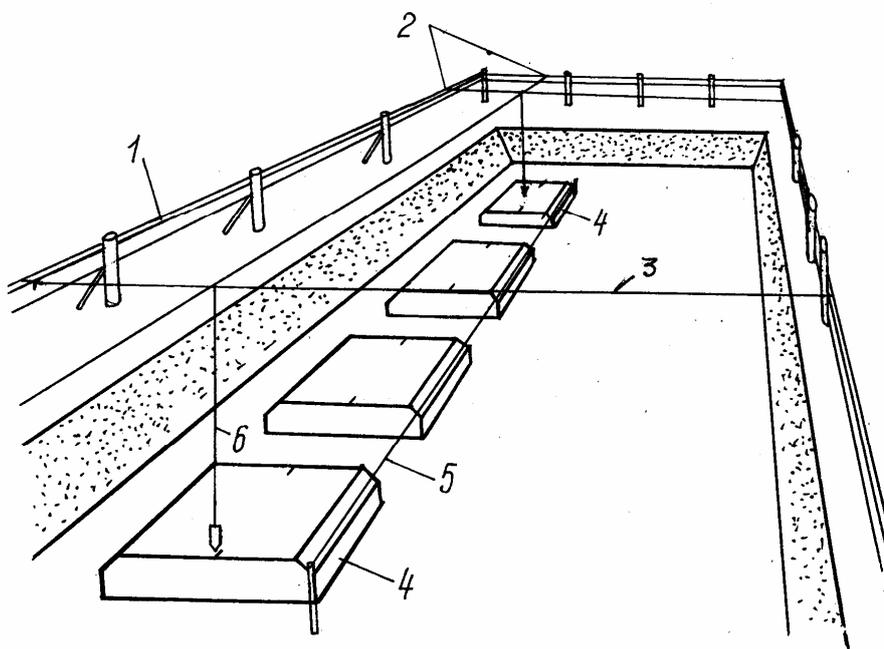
Схема перенесения разбивочных осей в котлован отвесами:
